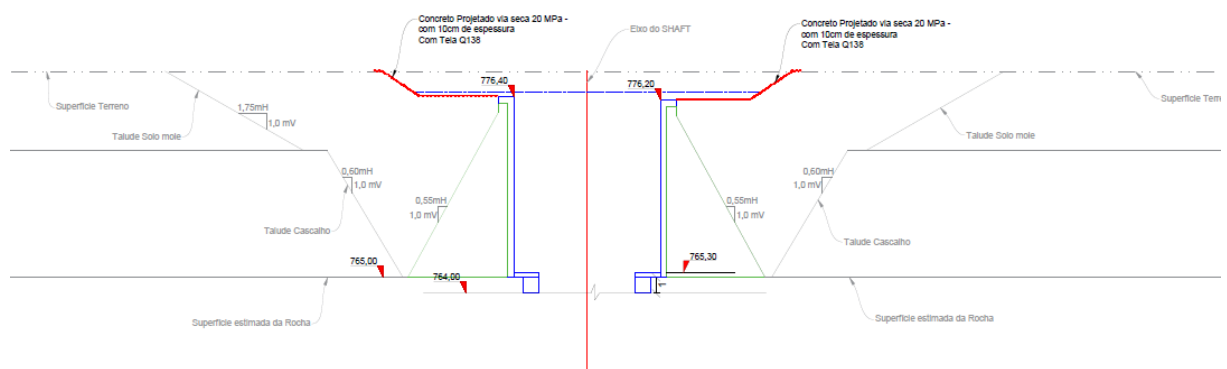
Seção B do muro (cota 764,00 a 776,40m) desenho (PMX-B-TUDE-0020-0).
